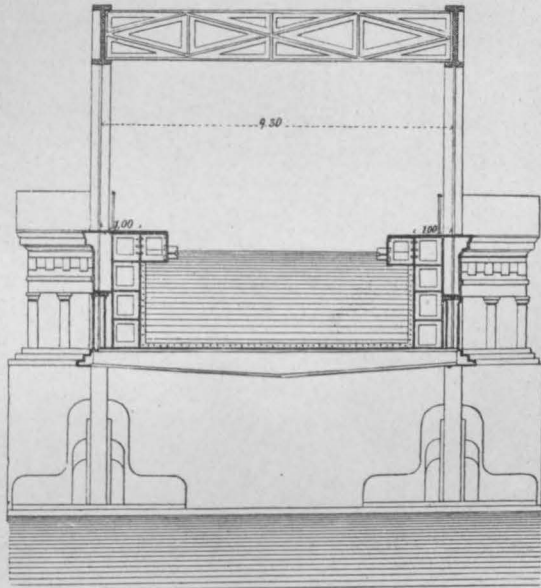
Querschnitt zur Calderbrücke in Fig. 379.
